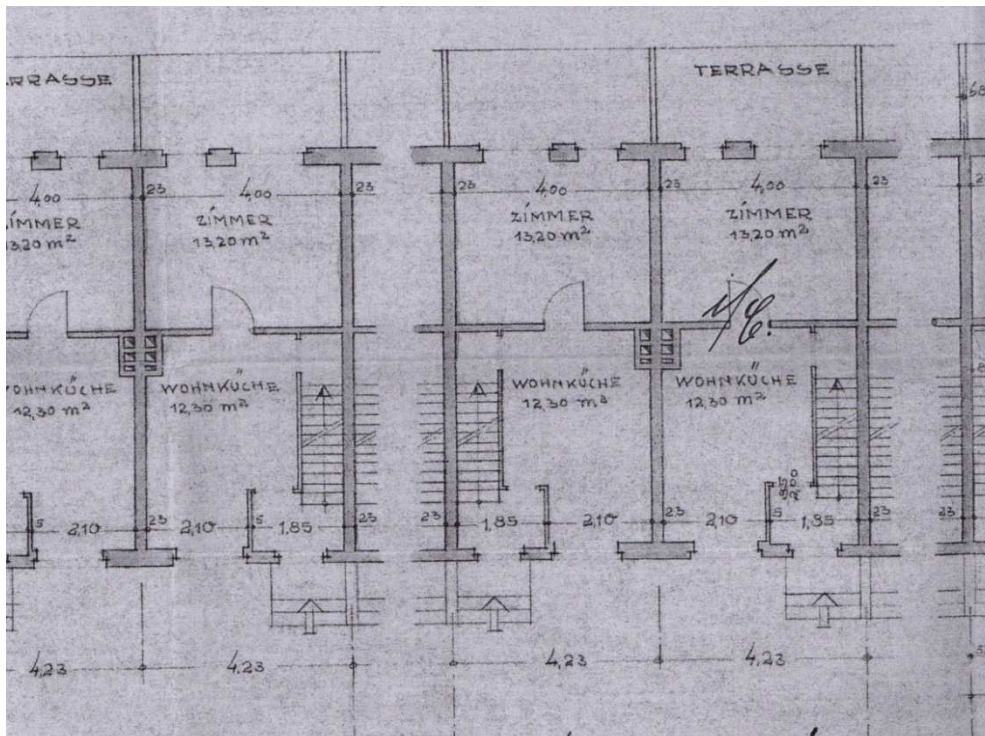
Grundriss Erdgeschoss aus der Bauantragszeichnung 1939
